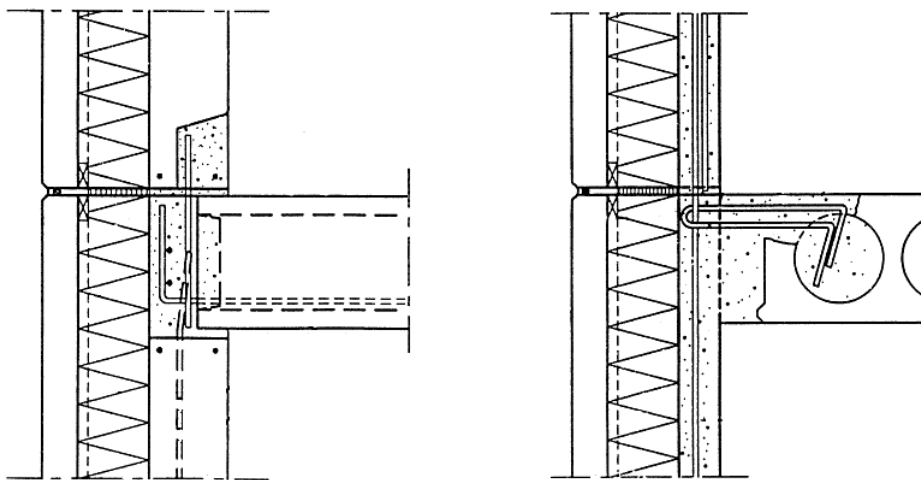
Ligação painéis sandwich - laje por sobreposição de armadura, adaptado de [31]
